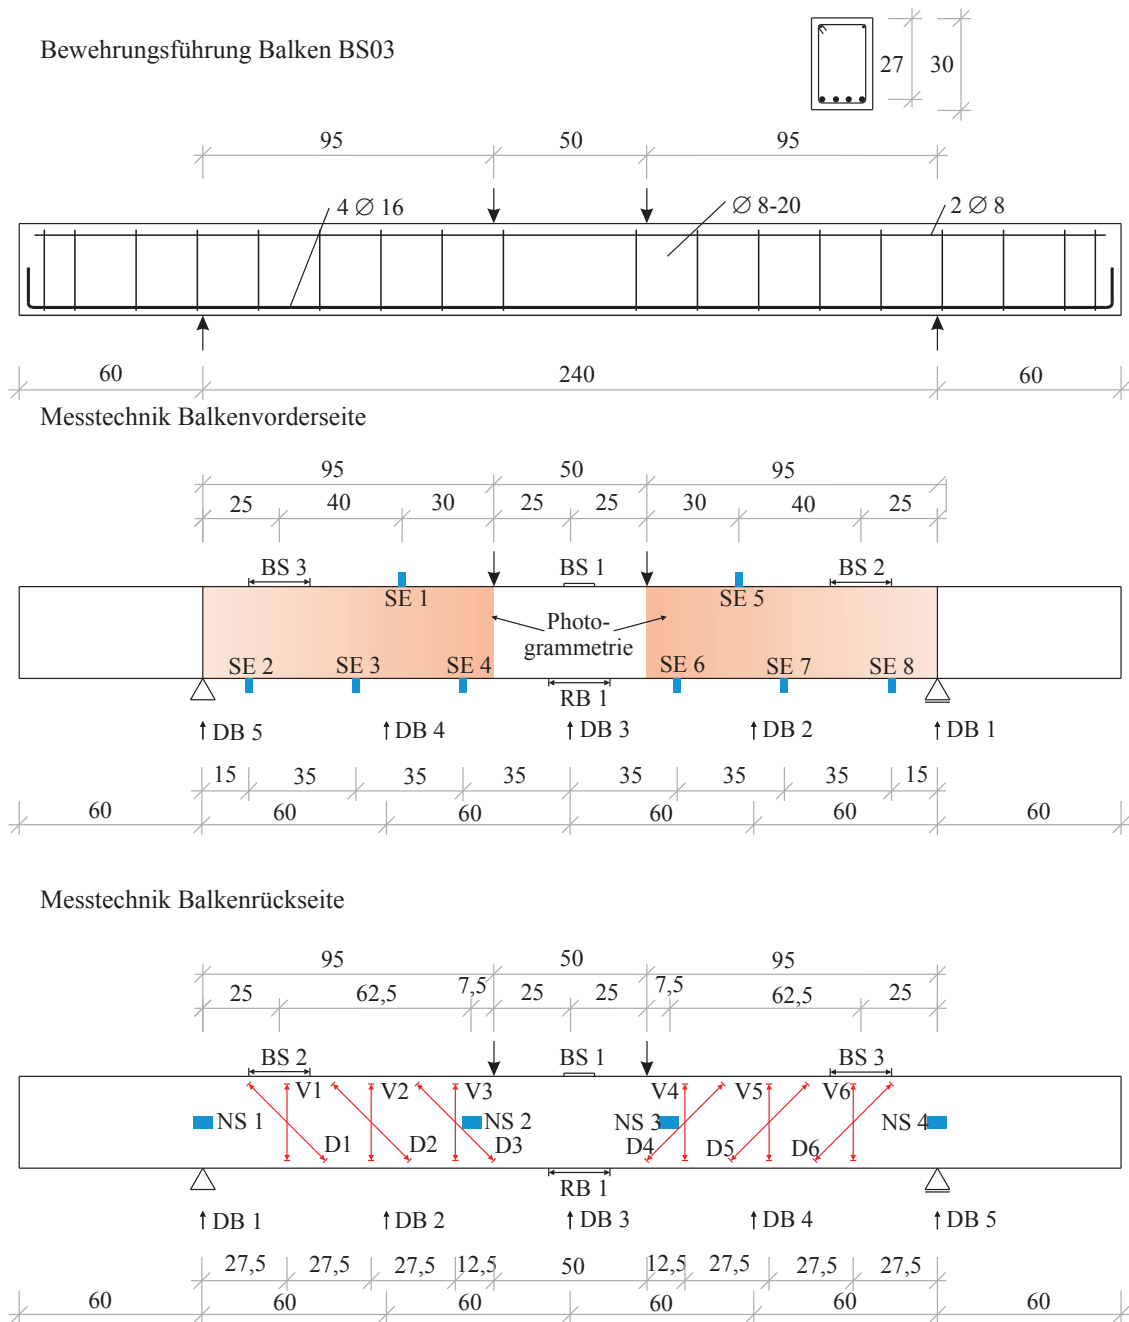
Bewehrungsführung und Anordnung der Messtechnik für Balken BS03
